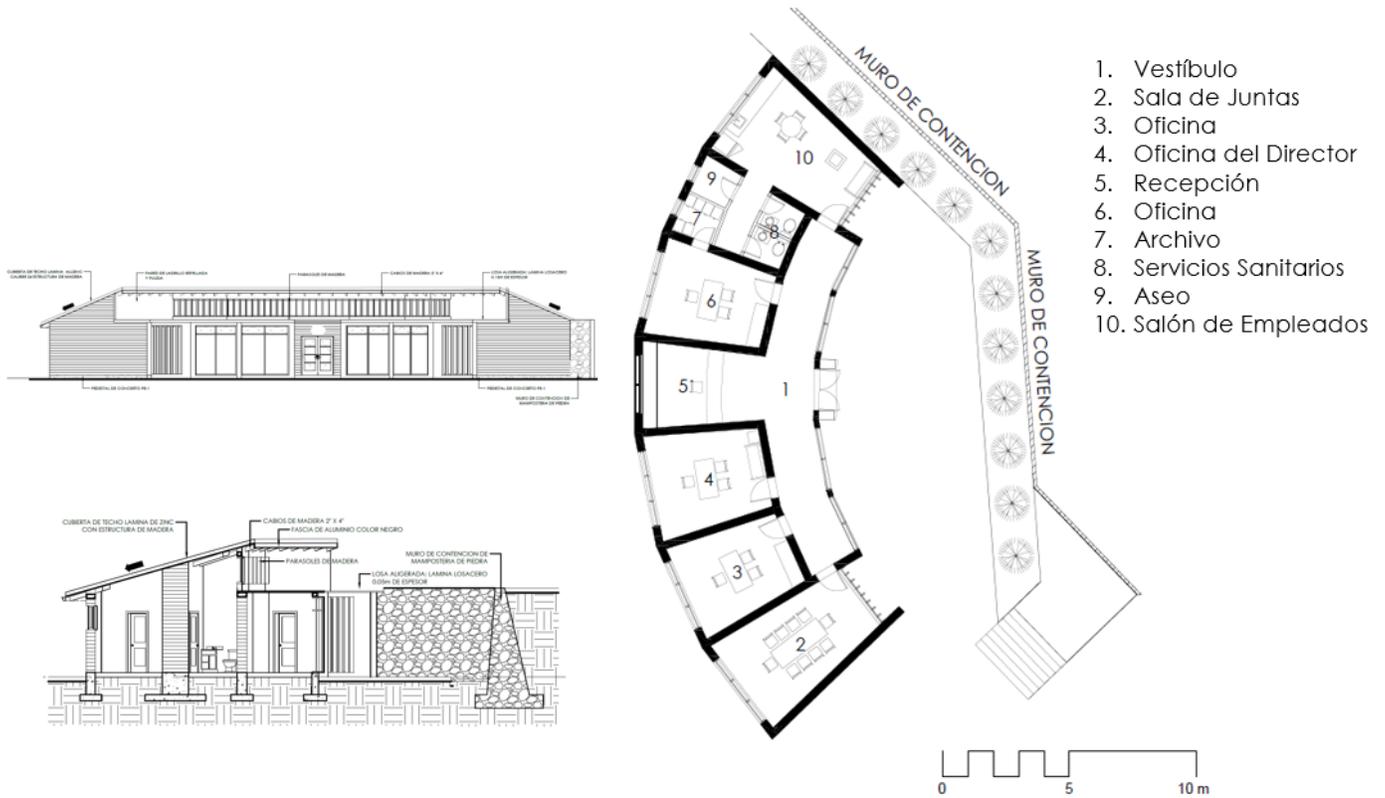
Planta Arquitectónica, Fachada y Corte - Edificio de Oficinas
